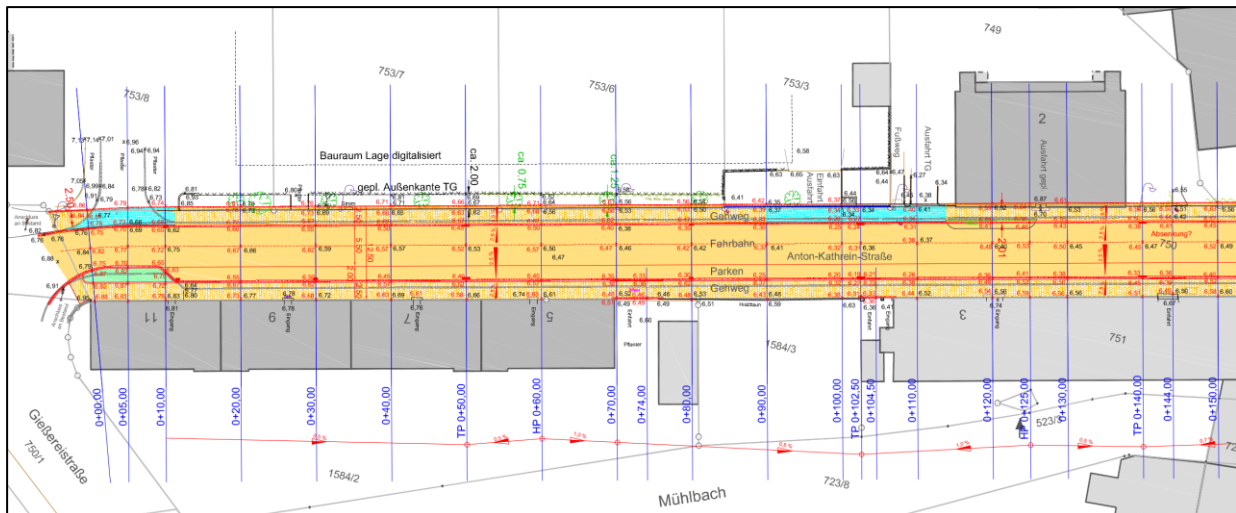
Ausschnitt aus dem Vorentwurf Variante 2 des Lageplans Straßenbau Anton-Kathrein-Straße, überarbeitet am 23.01.2024, Stadt Rosenheim
